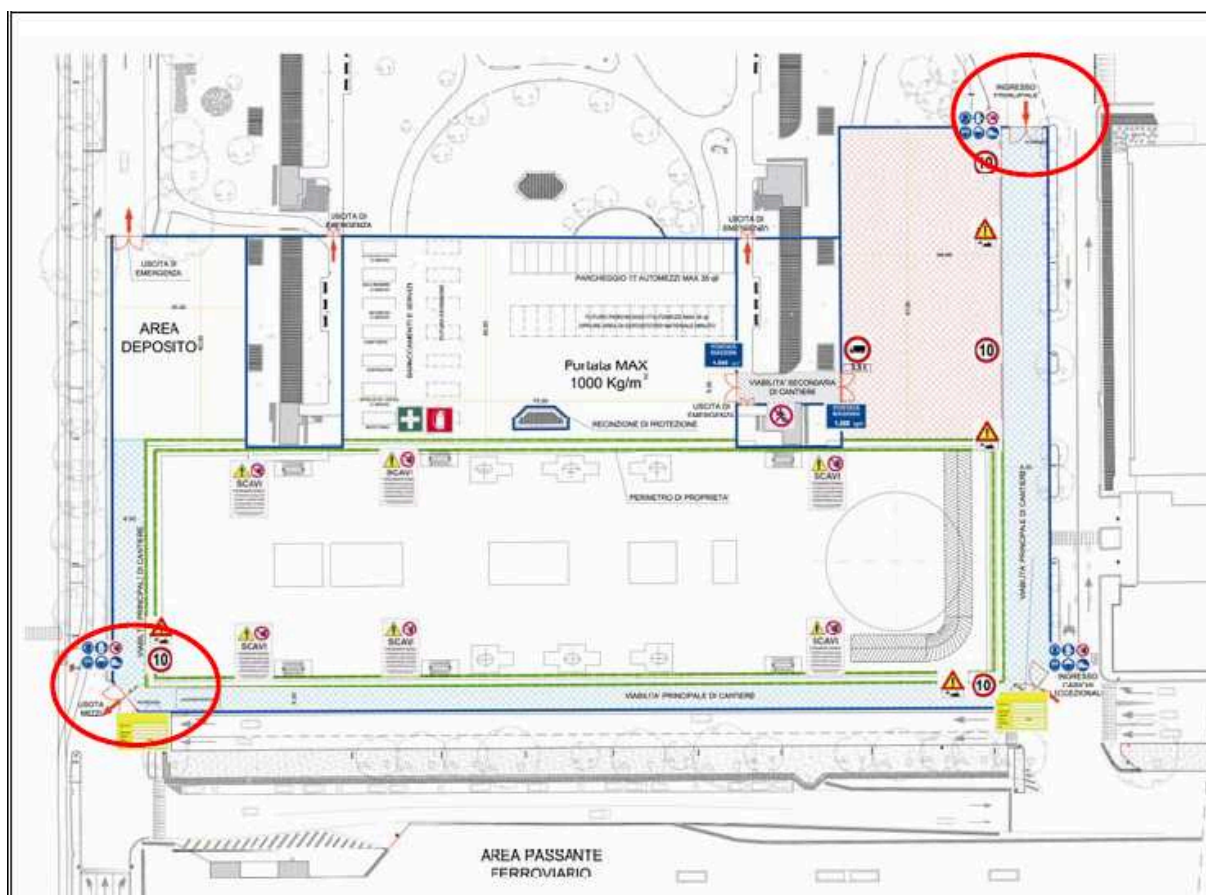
Planimetria di cantiere con l'indicazione dei cancelli principali presidiati (fonte: PSC, 2009)
